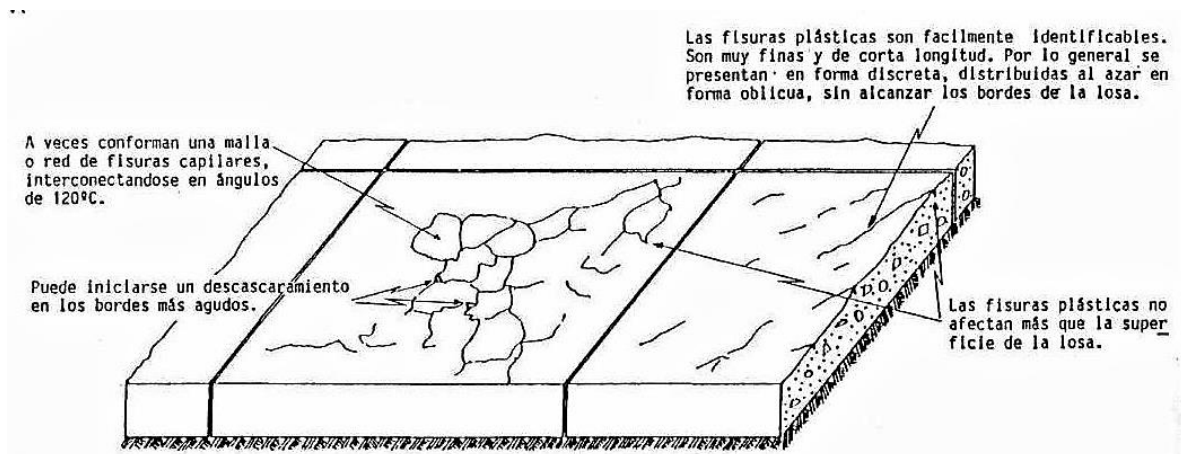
Esquema de fisuras plásticas o de contracción.¹¹⁹
